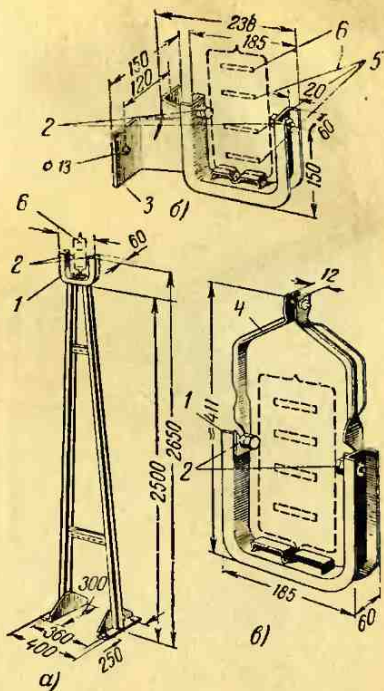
Установка секций ШРА-64 на опорных конструкциях.
